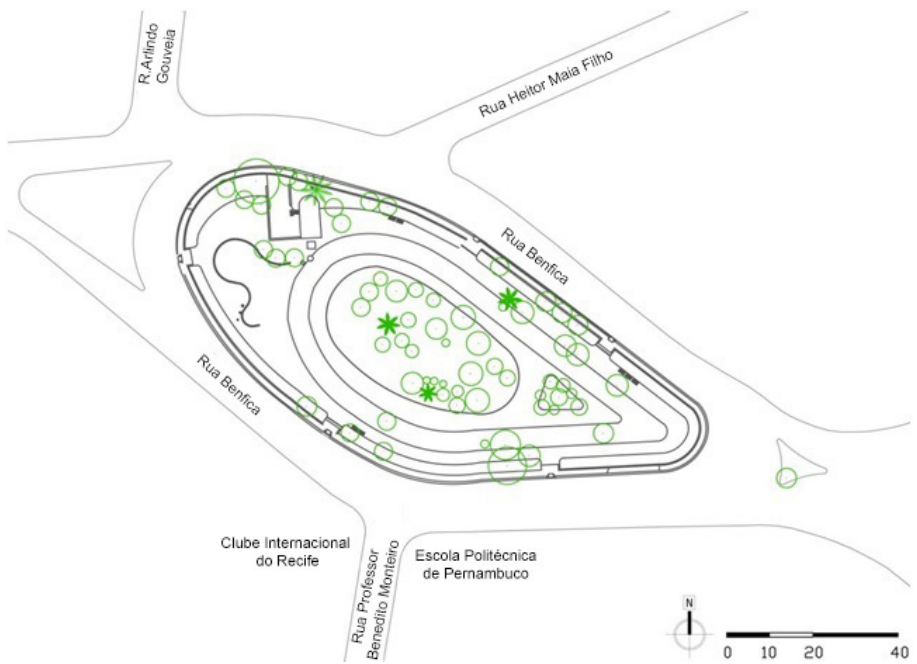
Planta de levantamento da vegetação, setembro/2003. Fonte: Emlurb/PCR
